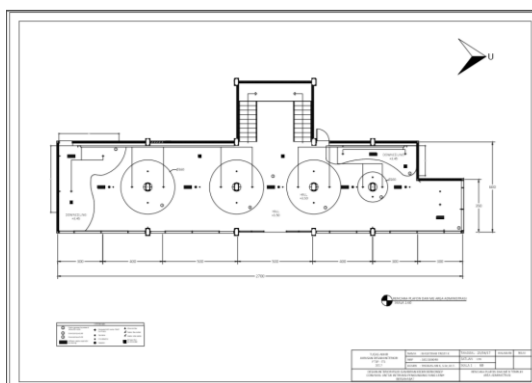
Rencana lantai ruang terpilih area administrasi
